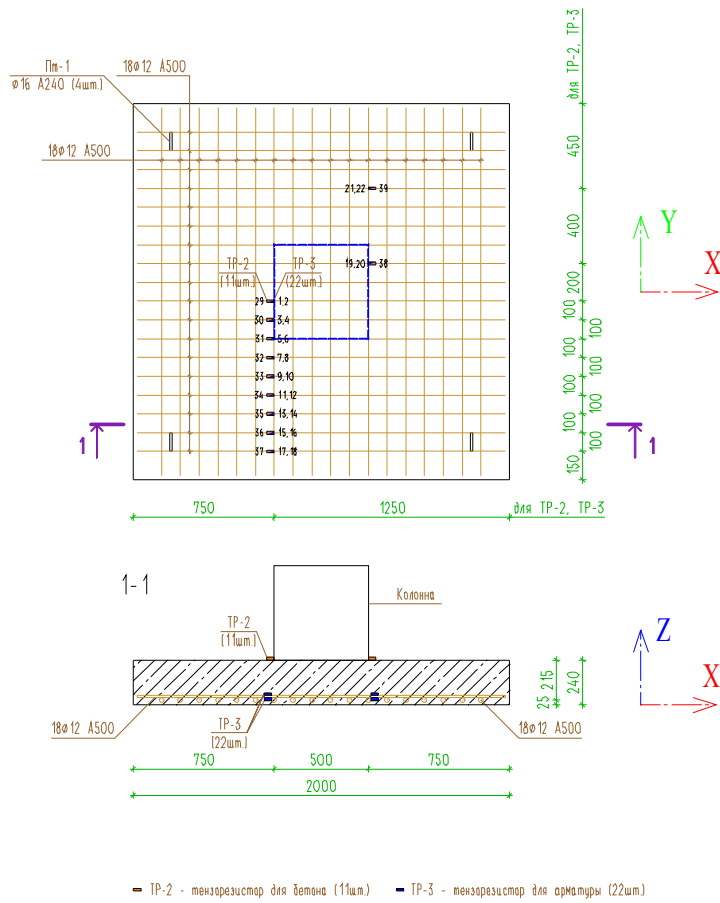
Фрагмент плиты перекрытия 2 (ФПП-2), РС62
